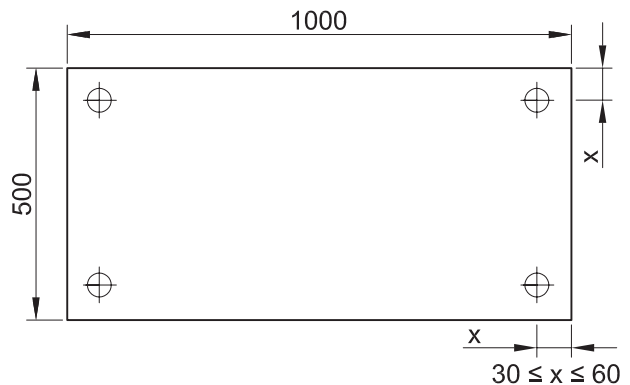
Colocación de las fijaciones en elementos horizontales.
